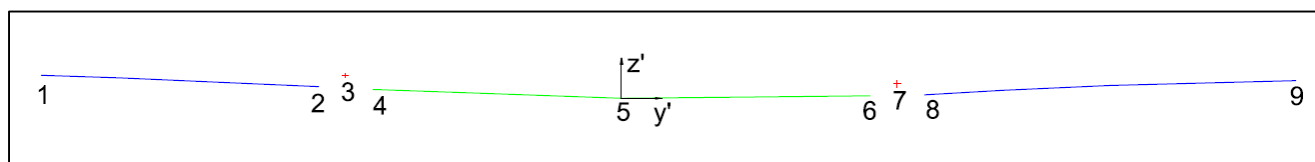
Numeración de los nudos por plano de vigas transversales en SAP2000. En azul se muestran las directrices de las vigas transversales en voladizo, en verde las de las vigas de piso centrales y en rojo la directriz de las vigas longitudinales
